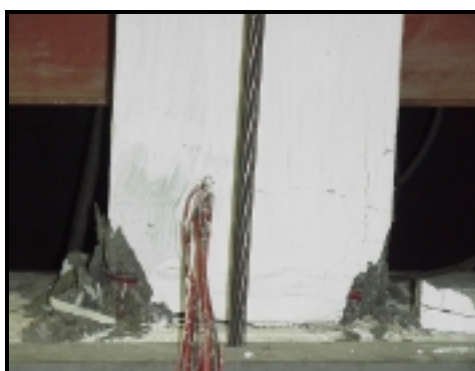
(a) - Fissuração da zona do encastramento do modelo M1G2.
